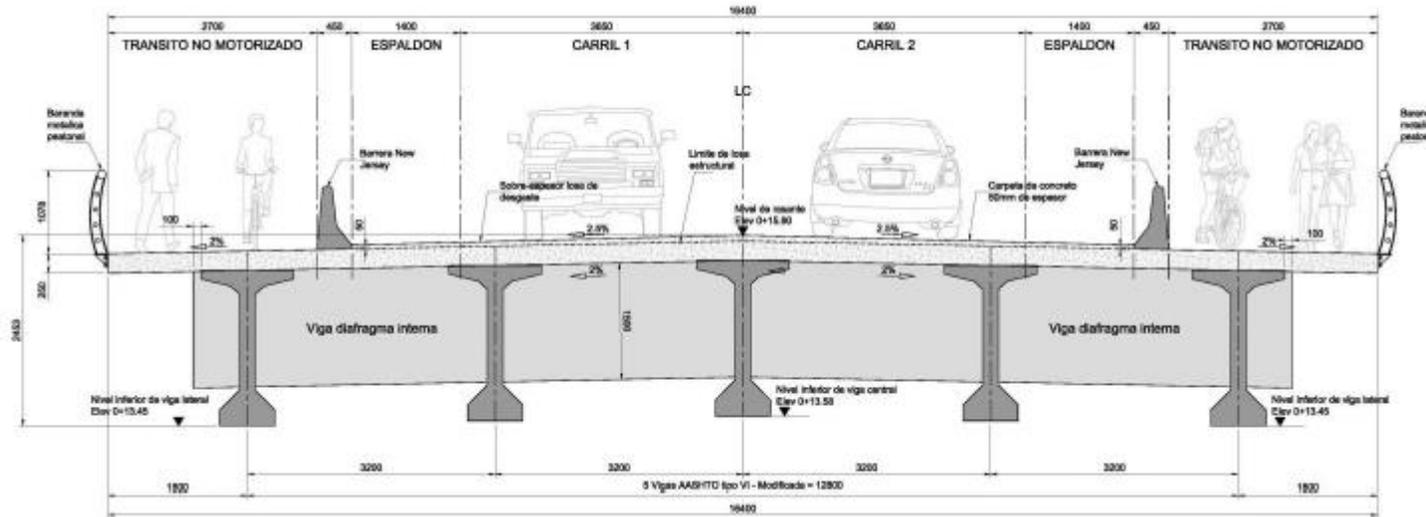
Sección Transversal Puente sobre Río Sixaola
